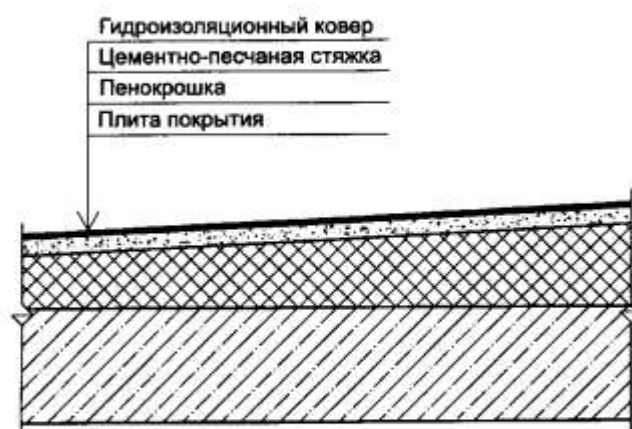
Тепловая изоляция совмещенной плоской кровли из пенокрошки
